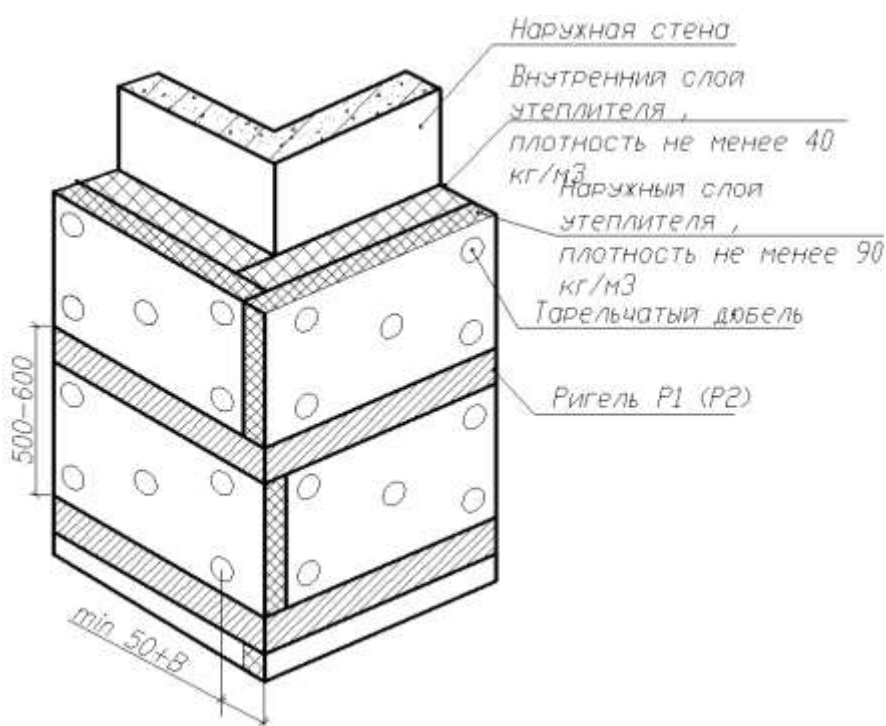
Схема крепления двухслойного утеплителя на углу здания
